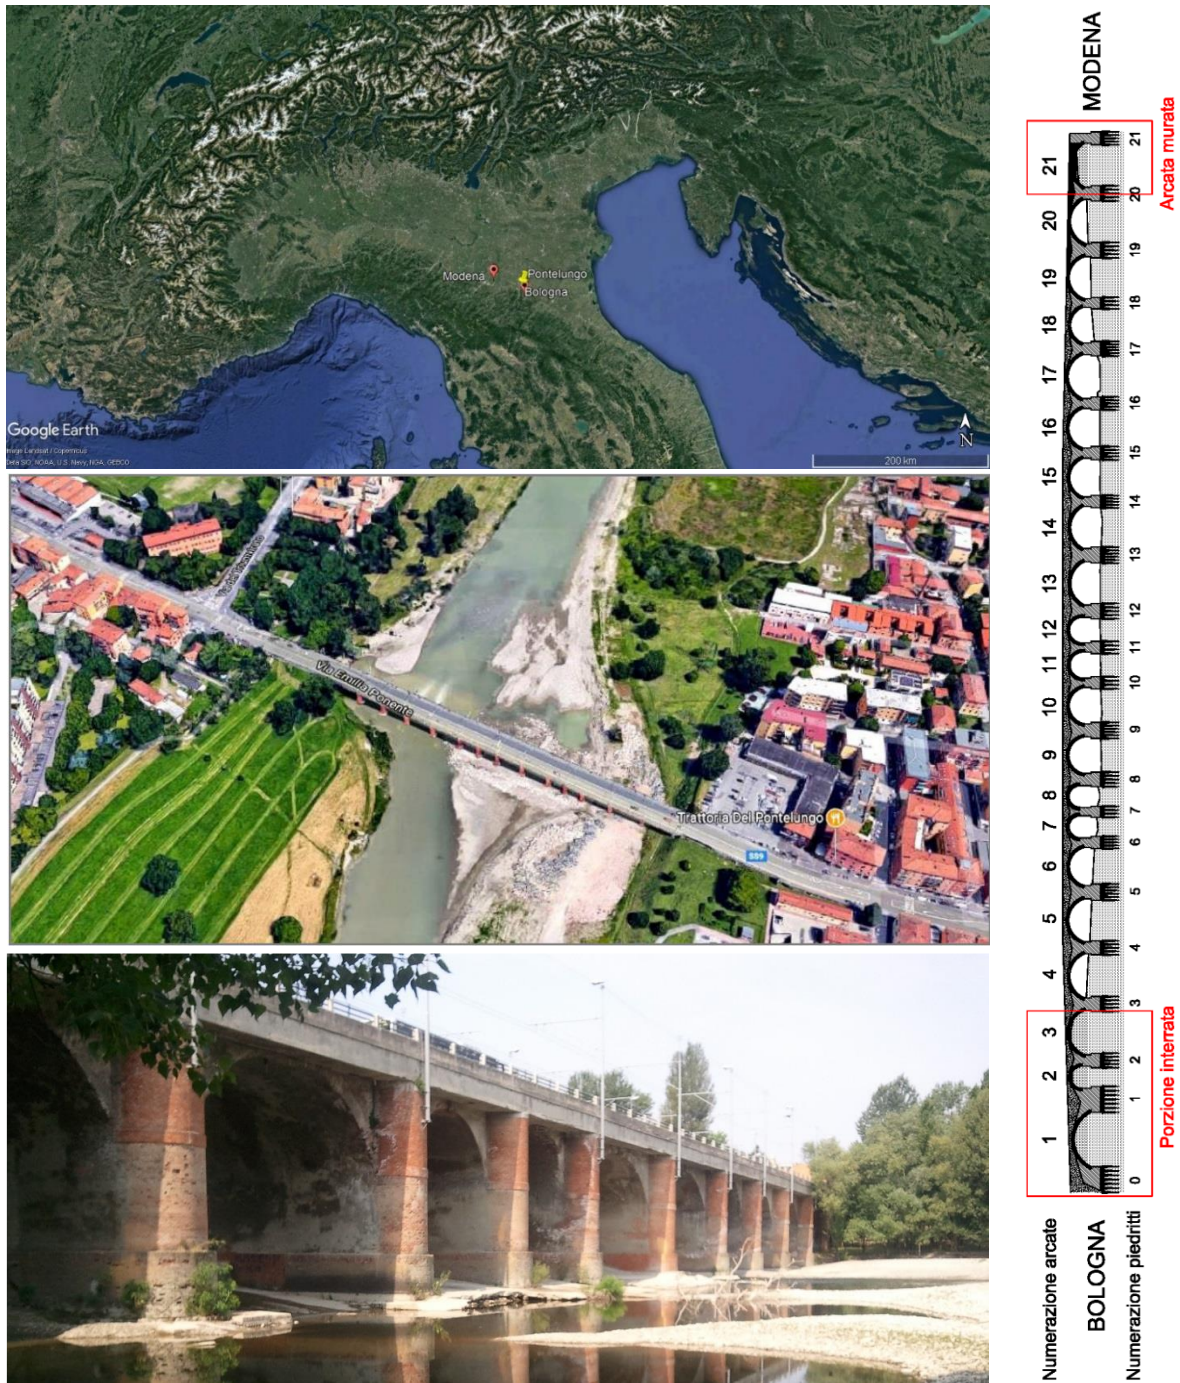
Posizione planimetrica del Pontelungo sul Reno, secondo le immagini satellitari fornite da Google Earth e Maps, prospetto sud del ponte [25] (in ordine, dall'alto verso il basso, a sinistra) e prospetto nord del ponte con indicazione della numerazione dei piedritti e delle arcate (a destra).
